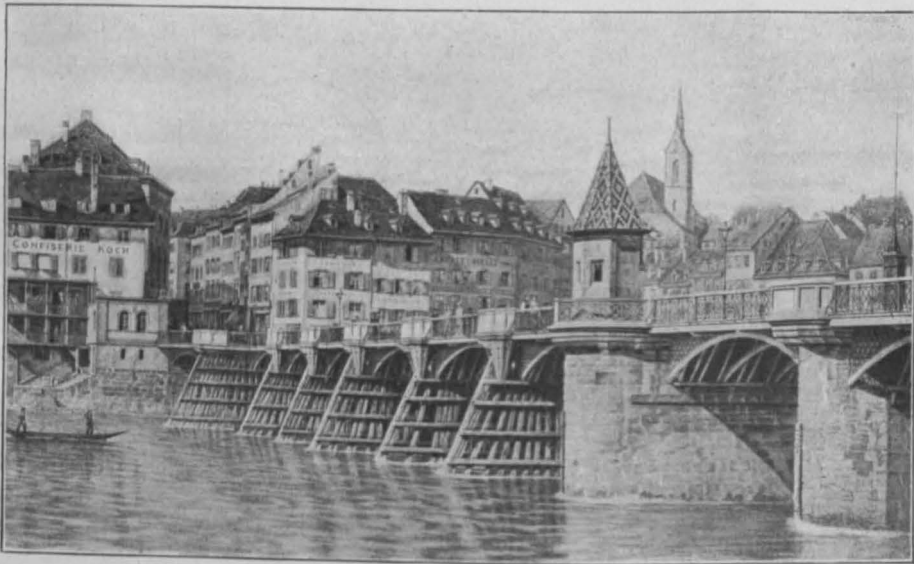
Alte Rheinbrücke in Basel, erbaut 1225, abgebrochen 1903.
